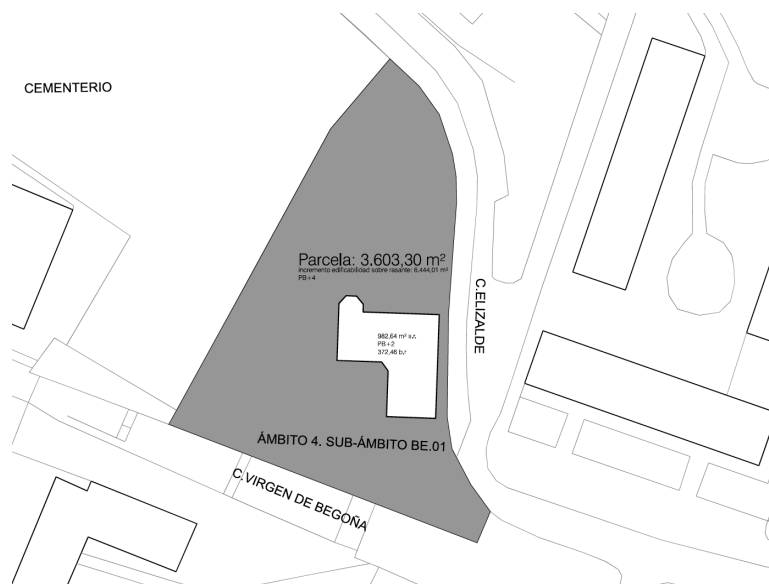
Plano de la Residencia de los Venerables Sacerdotes, Bilbao
